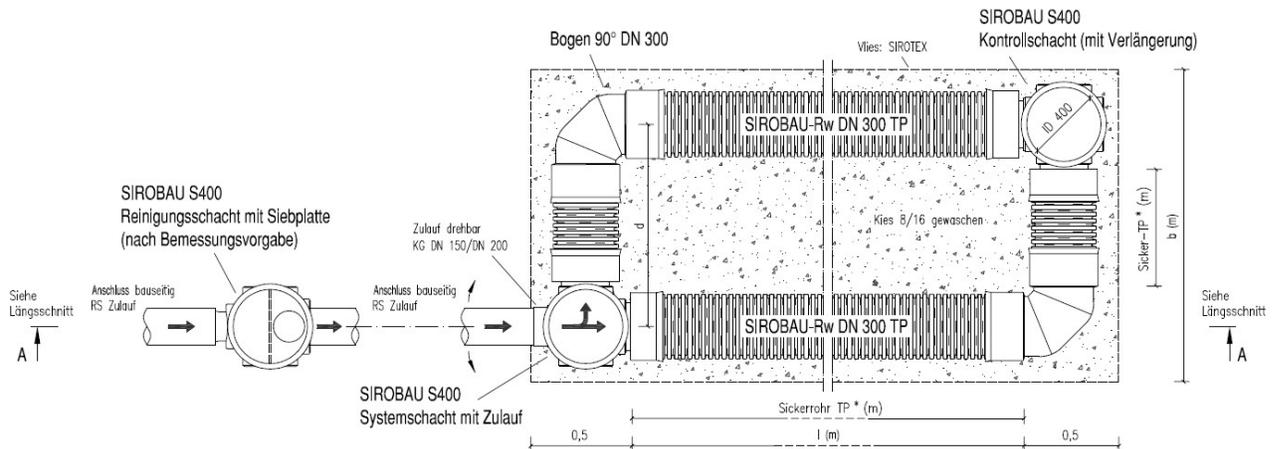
Rohrrigole, schematischer Grundriss mit Vorreinigung, Verteilerschacht/Formteile und Sickerrohr
